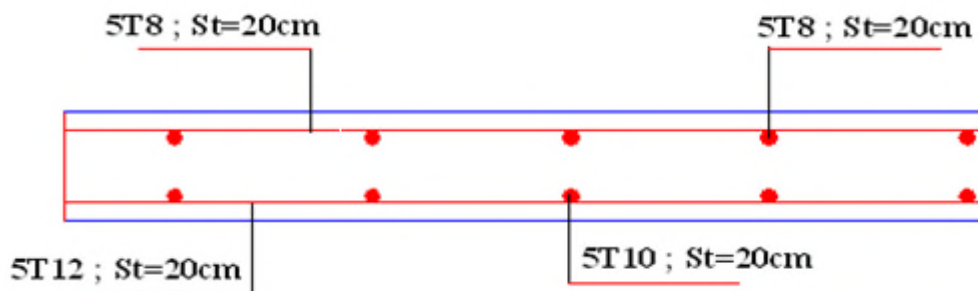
Ferrailage de la dalle pleine sur 3 appuis
